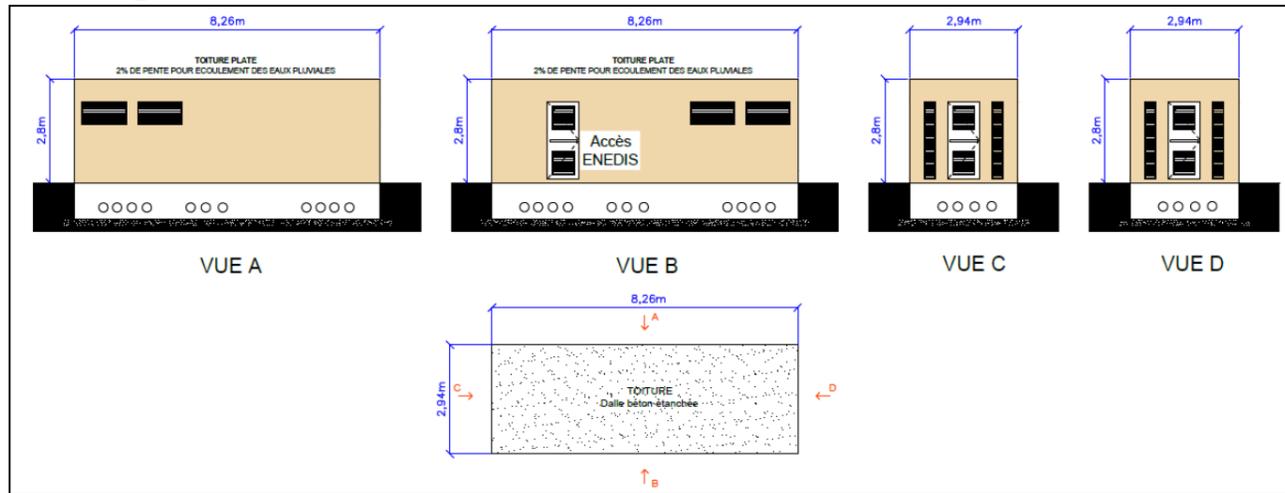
Plan de façades local technique (Source : Total QUADRAN)
